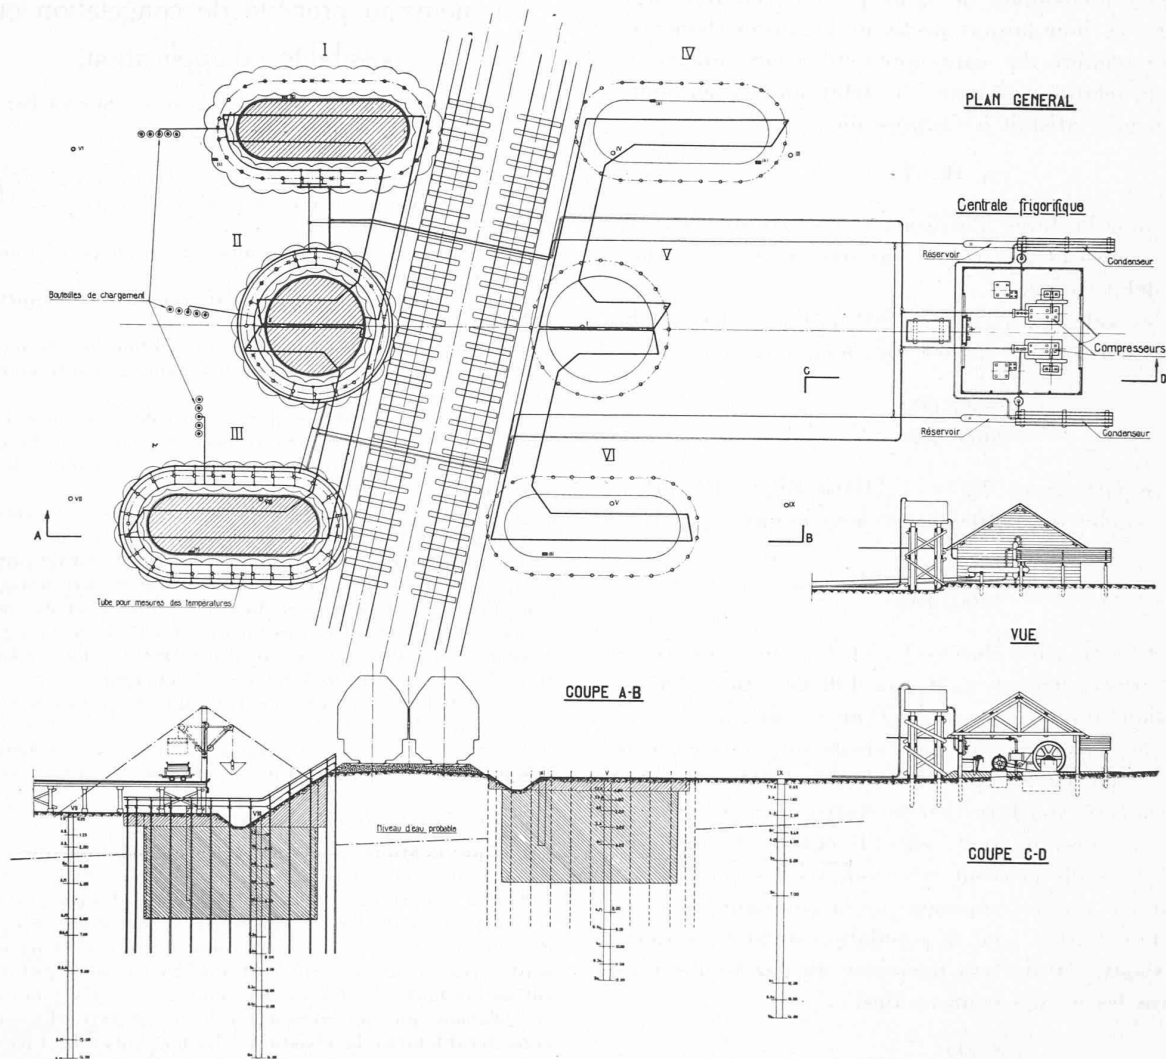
Fondation d'un pont par congélation. — Echelle 1 : 400.
